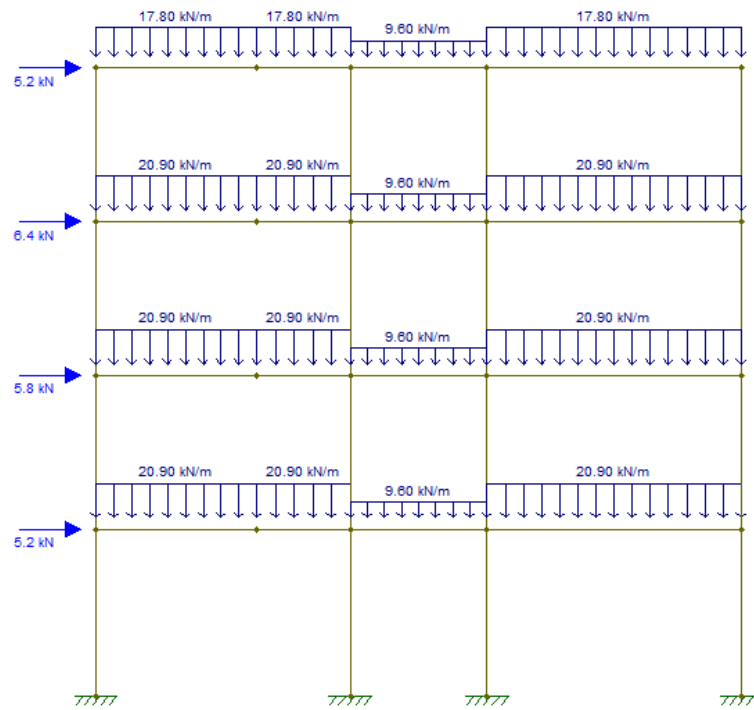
Pórtico 7 carregado, vigas V7 e V8.
